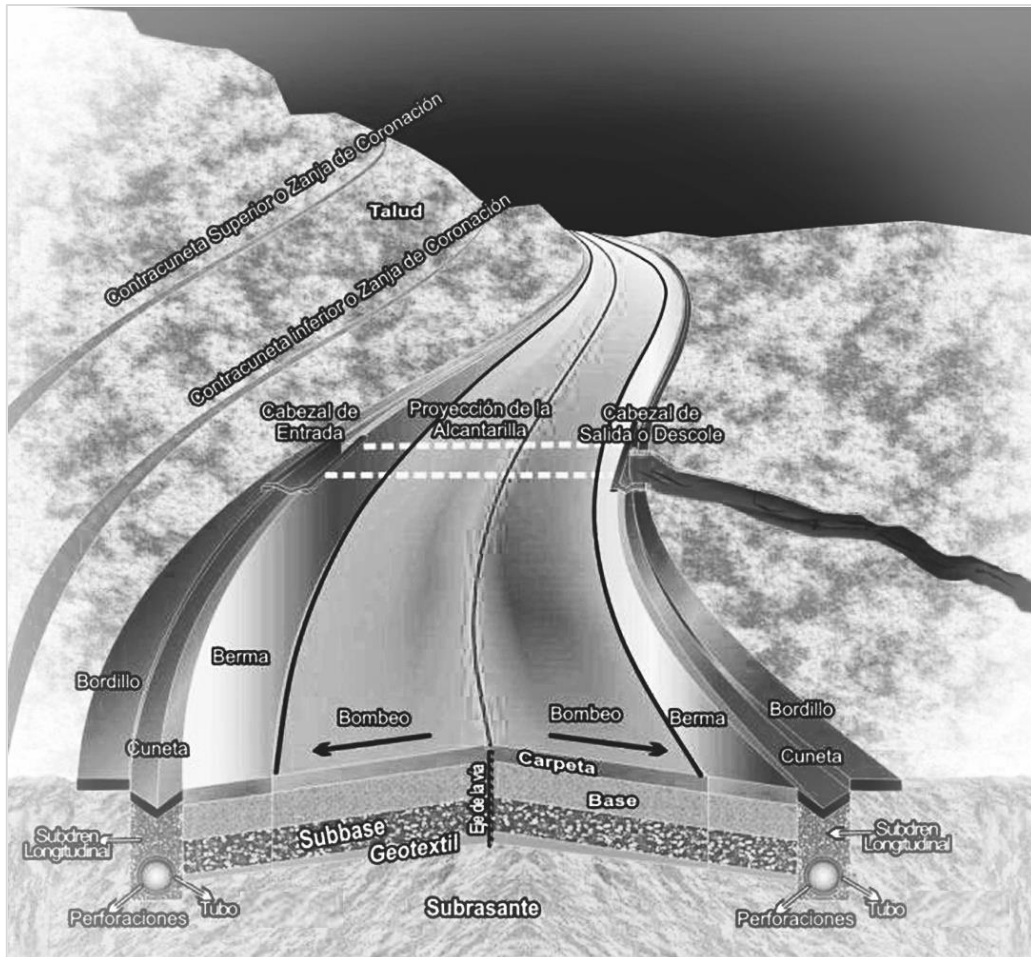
Sección típica con sistemas de drenaje y subdrenaje
